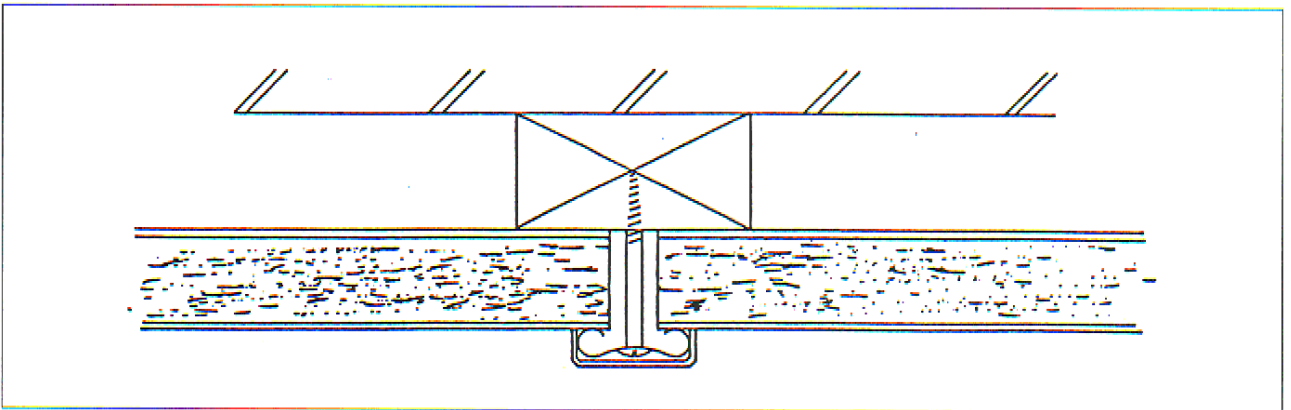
Metallklammern, auf Unterkonstruktion verschraubt und mit einem Profil abgedeckt
